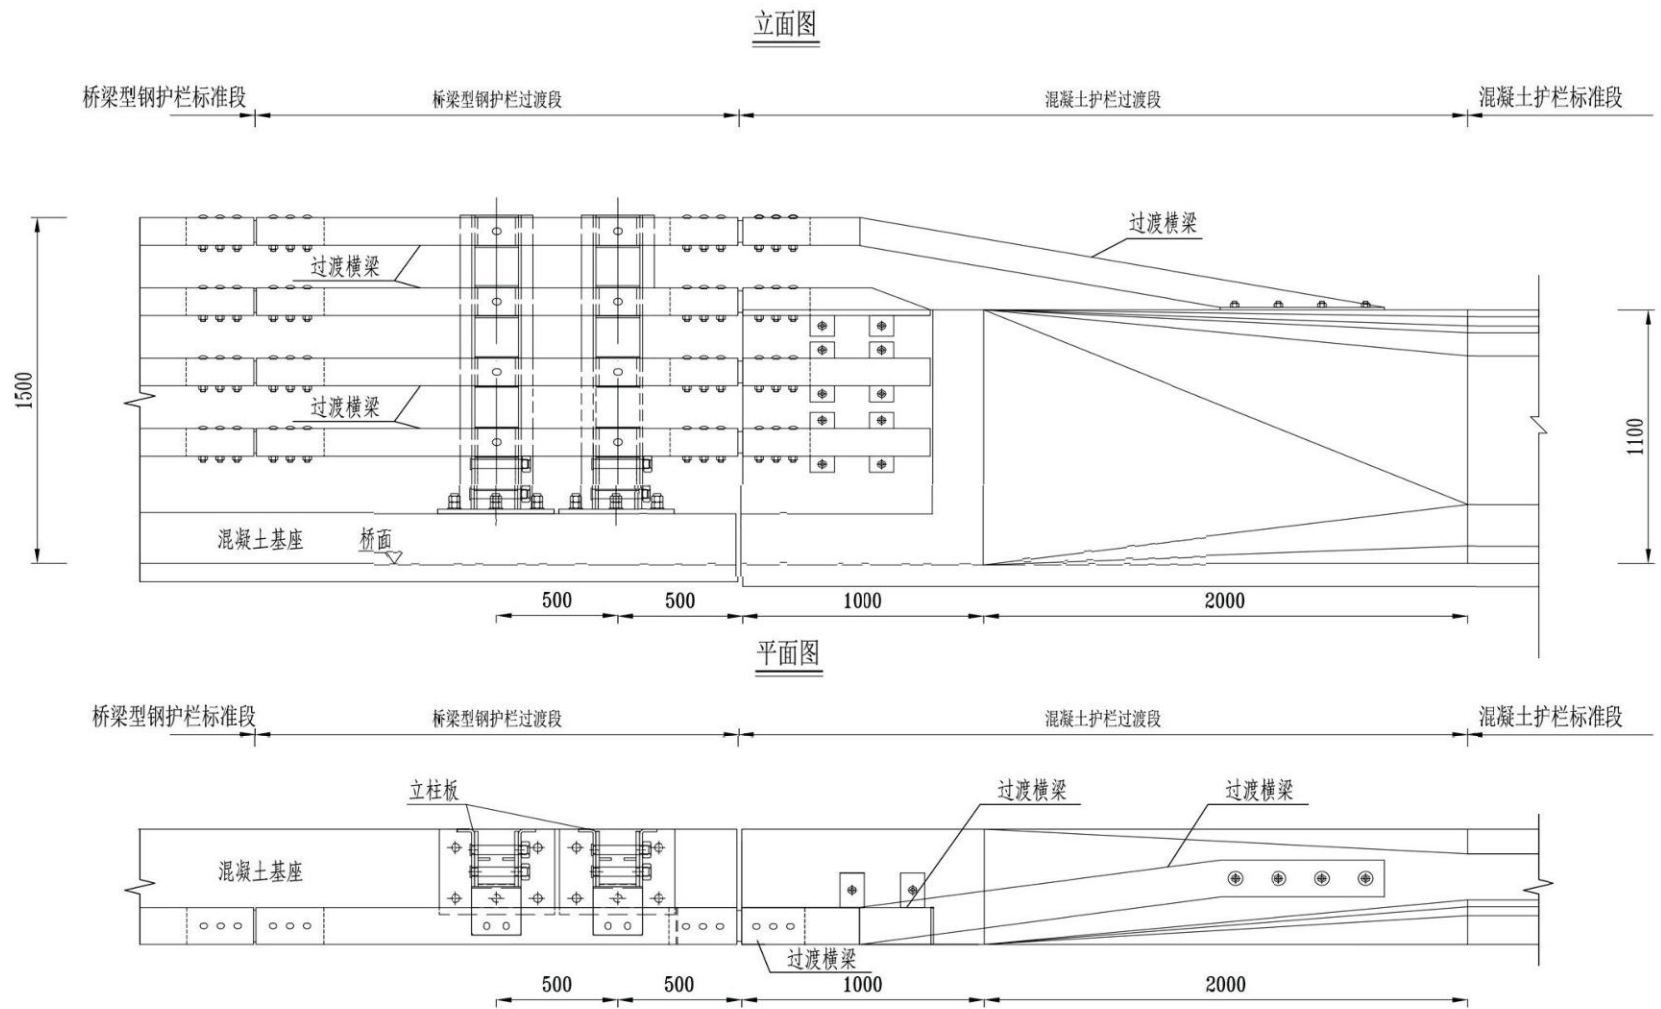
六 (SS) 级金属梁柱式护栏与六 (SS) 级混凝土护栏过渡结构图示例 (单位: mm)
